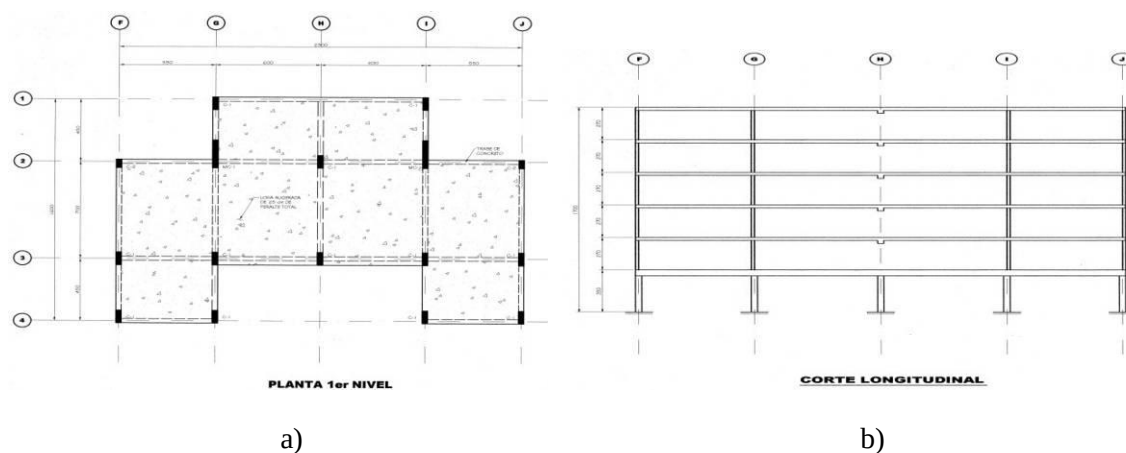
a) Vista en planta primer nivel, b) Vista en elevación, corte longitudinal
